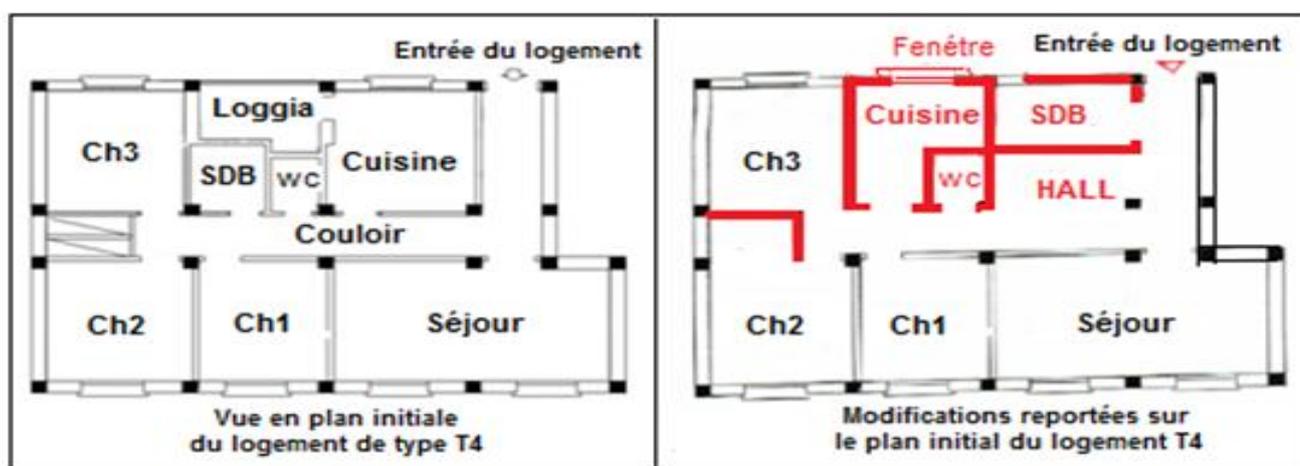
Les modifications reportées sur le plan initial du logement de type T4.
